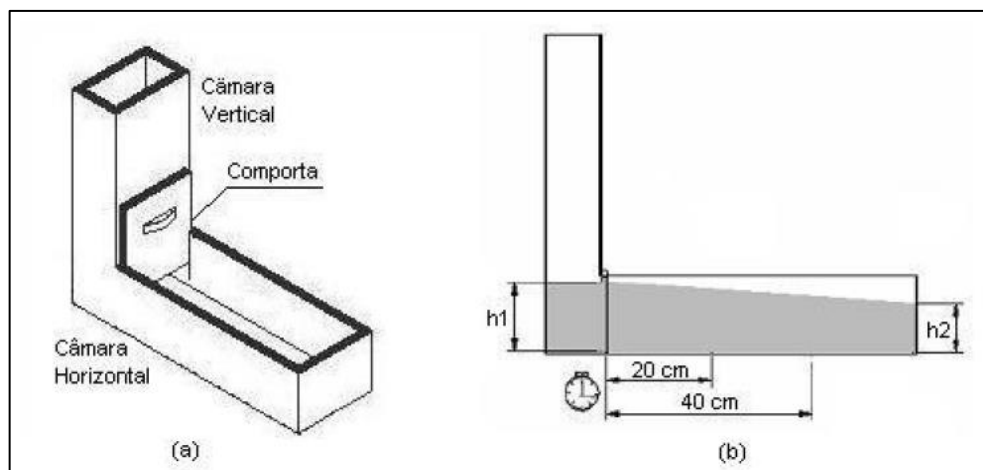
(a) Caixa em L; (b) Vista lateral da caixa L e esquema de ensaio
